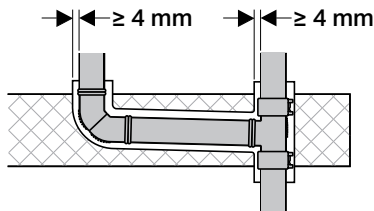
Все трубопроводы, установленные внутри строительной конструкции, необходимо изолировать для поглощения теплового расширения
